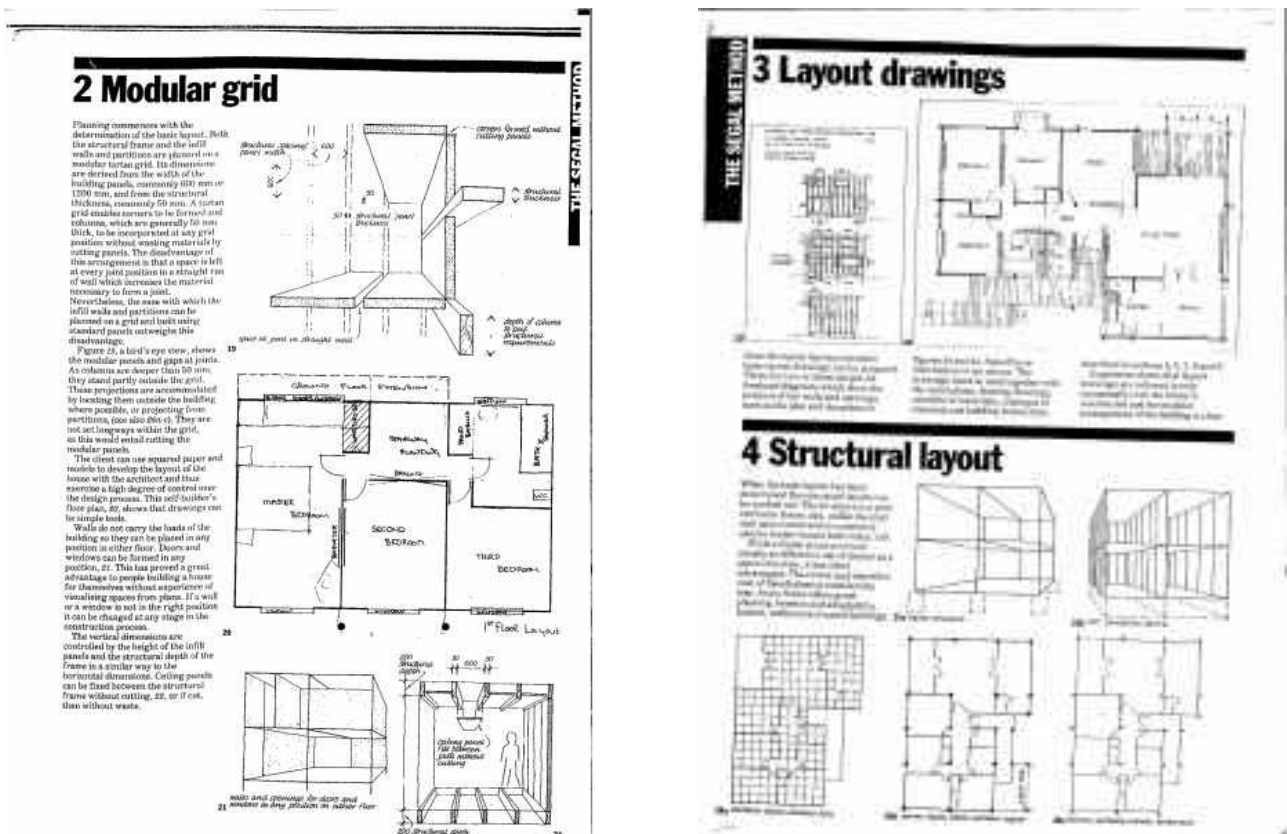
Páginas do manual de Auto-Construção de Walter Segal.
